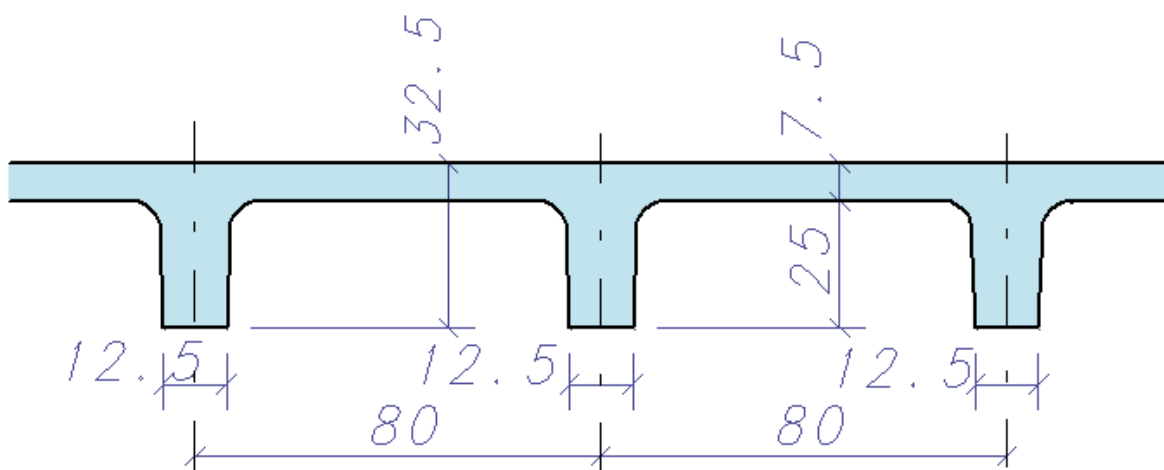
Seção transversal da laje nervurada ATEX 800 25+7,5.
